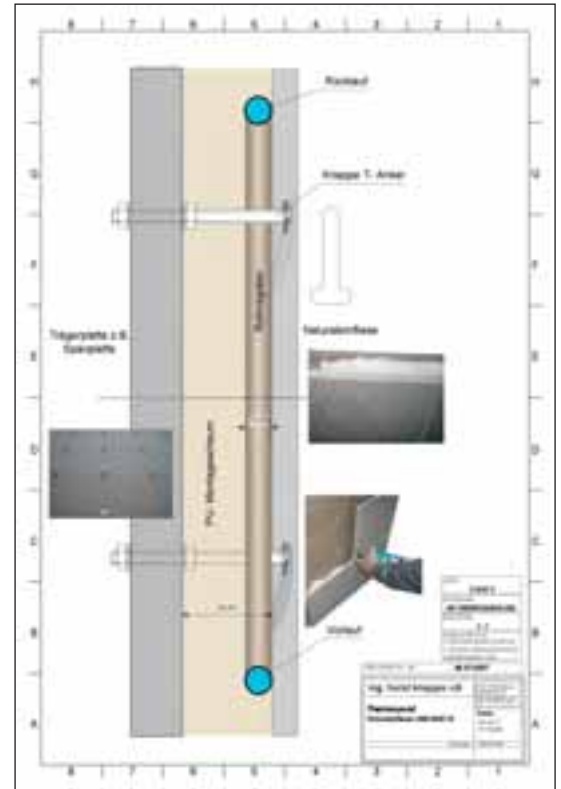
Schnitt durch ein vorgefertigtes Wandelement mit Rohrregister
